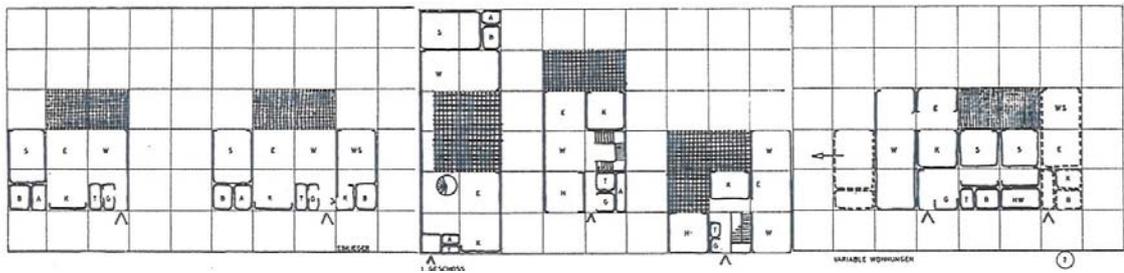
Grundrissvarianten innerhalb der Struktur
